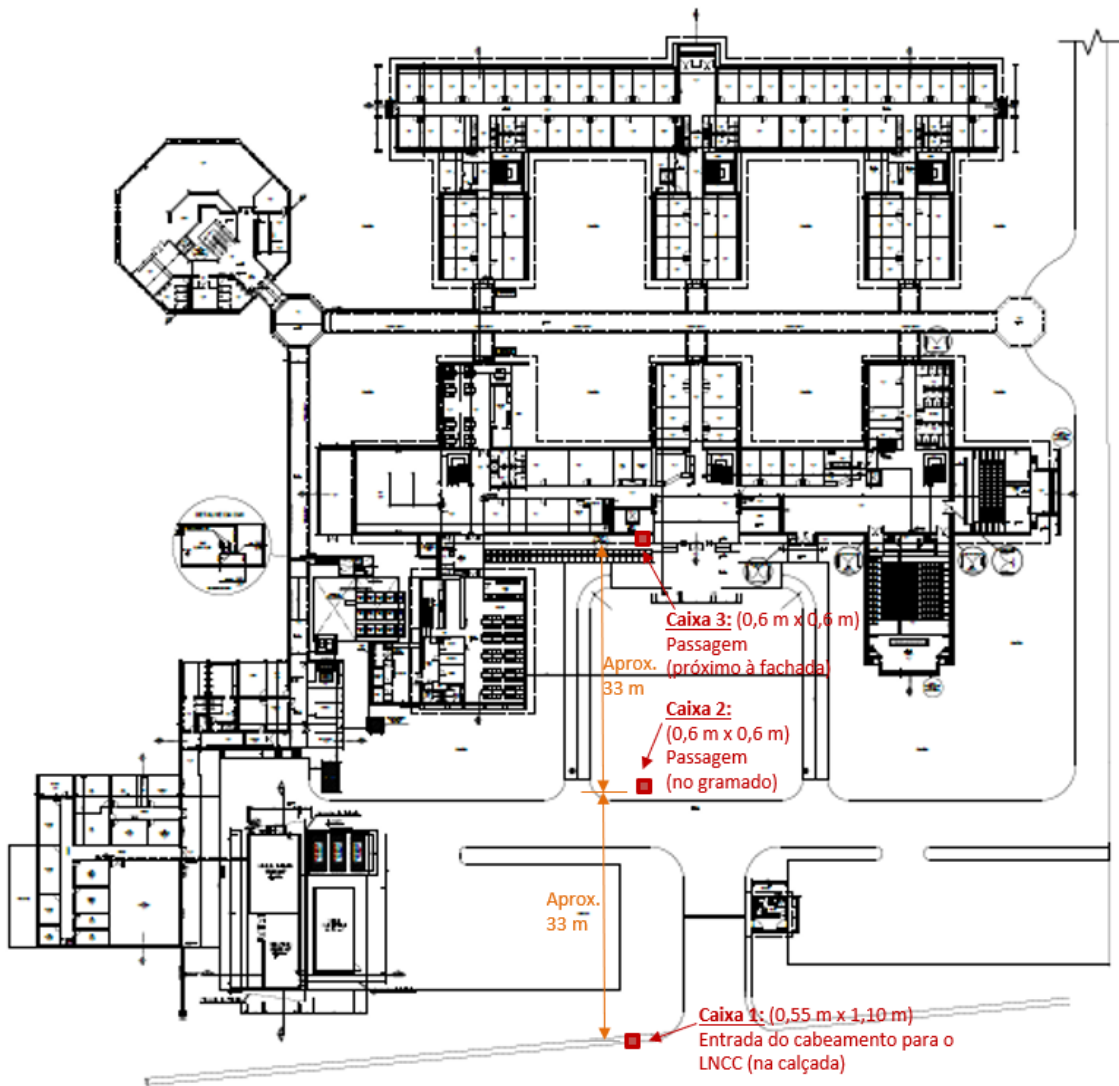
Planta esquemática do LNCC com indicações das caixas de entrada e de passagem para o cabeamento de telefonia e das respectivas distâncias aproximadas em planta entre estas caixas.
